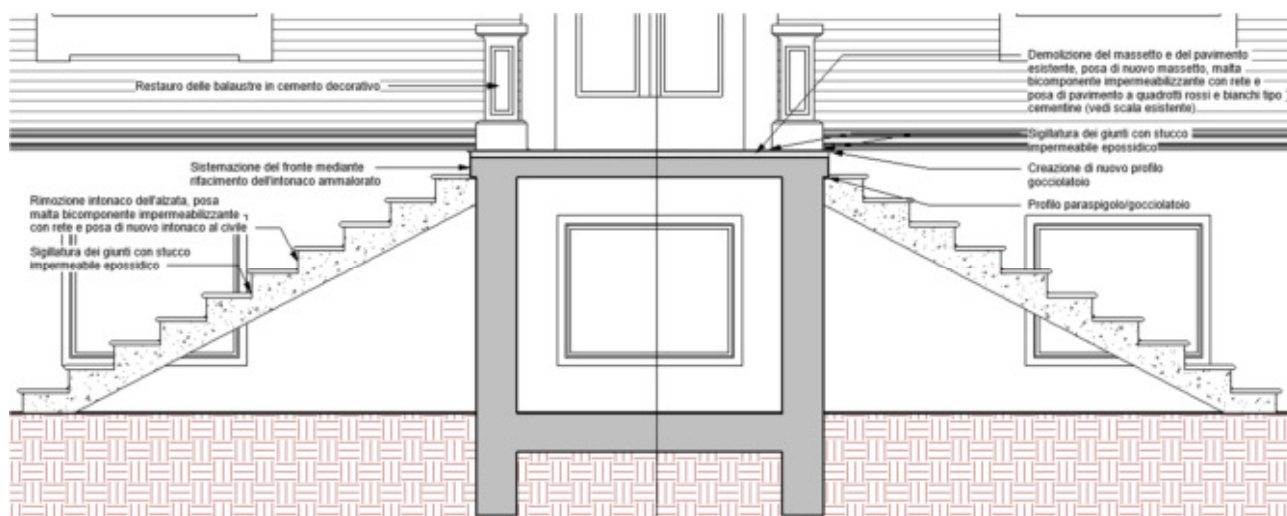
Restauro conservativo delle scale esterne 01 – Sezione A
